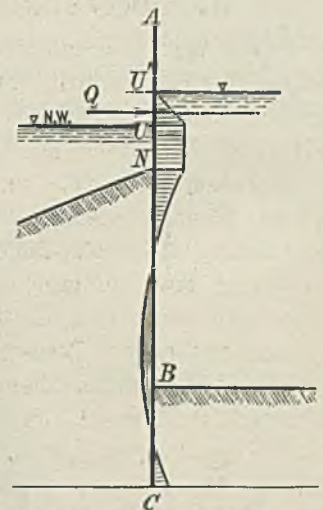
Spundwände für Beton Gründungen. Vereinfachtes Belastungsschema bei innerem Überdruck.
